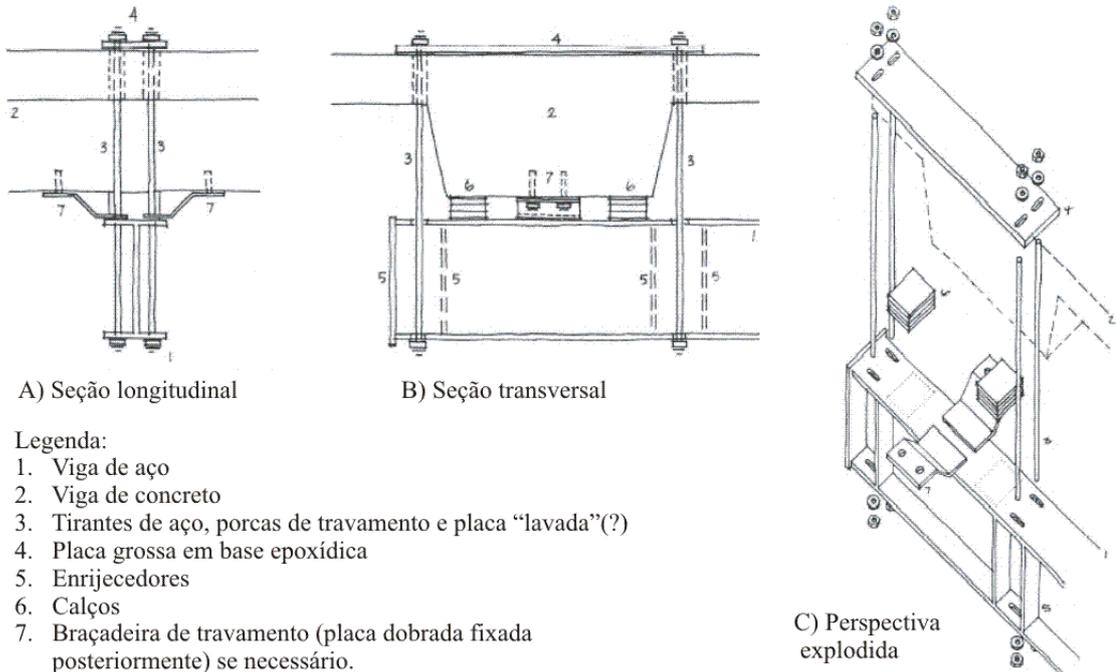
Carregamento em viga de aço engastada em viga de concreto.
